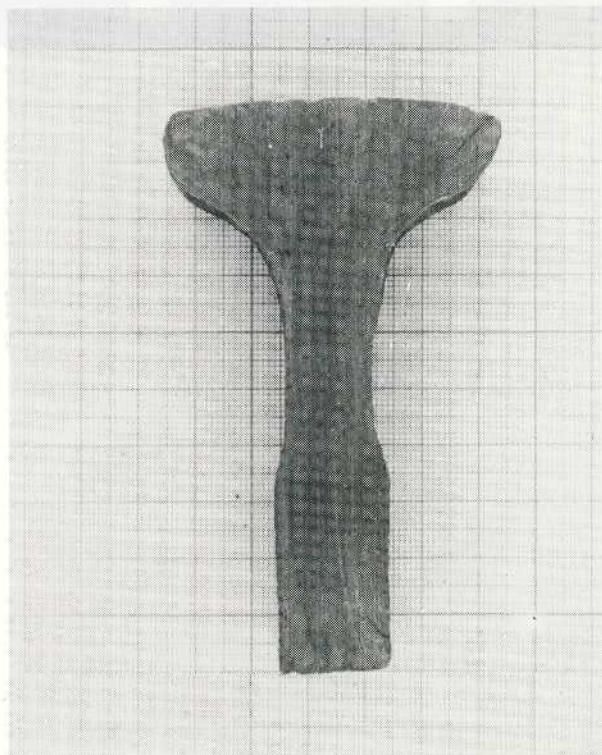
Section d'un rail subondulé mis à jour à l'occasion de travaux de terrassement à Malines.
